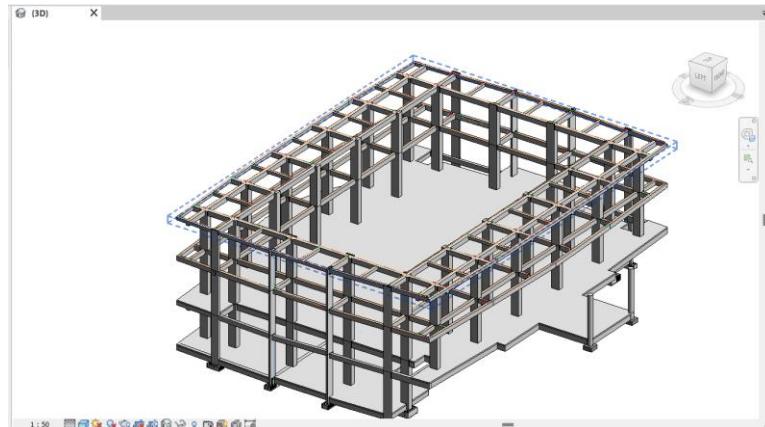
22 Tampilan Pemodelan Balok Lantai 2
